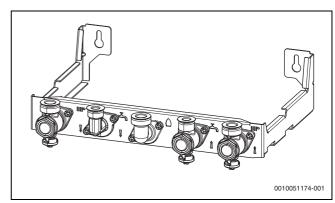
Installazione dei tubi completi di guarnizioni sulla piastra di allacciamento e montaggio
